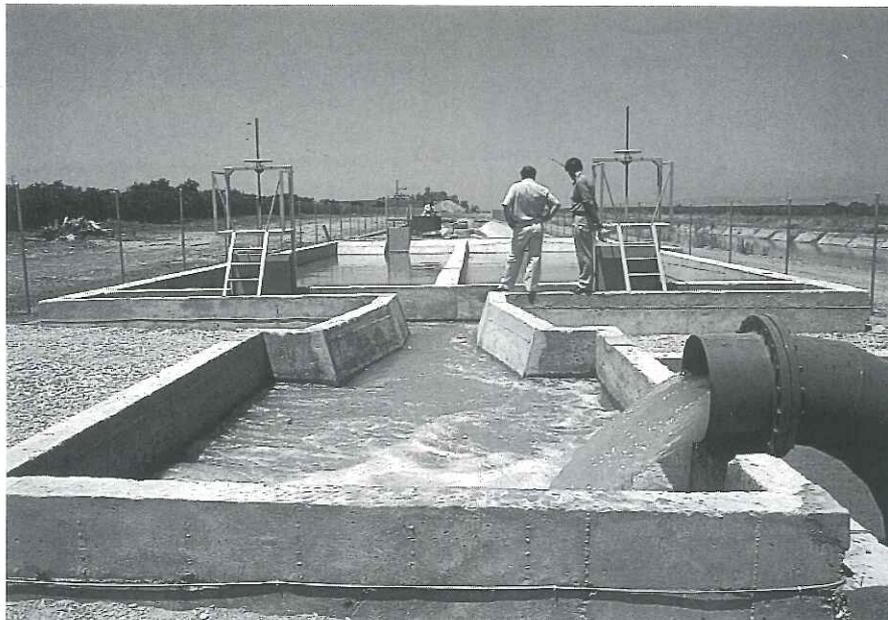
Detalle de la unidad de bombeo, en primer plano, y de balsas de decantación.
